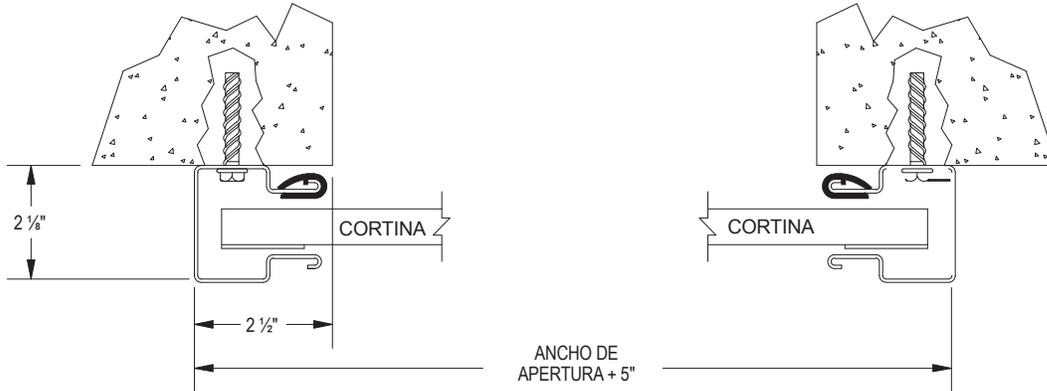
JAMBAS DE HORMIGÓN/MAMPOSTERÍA
